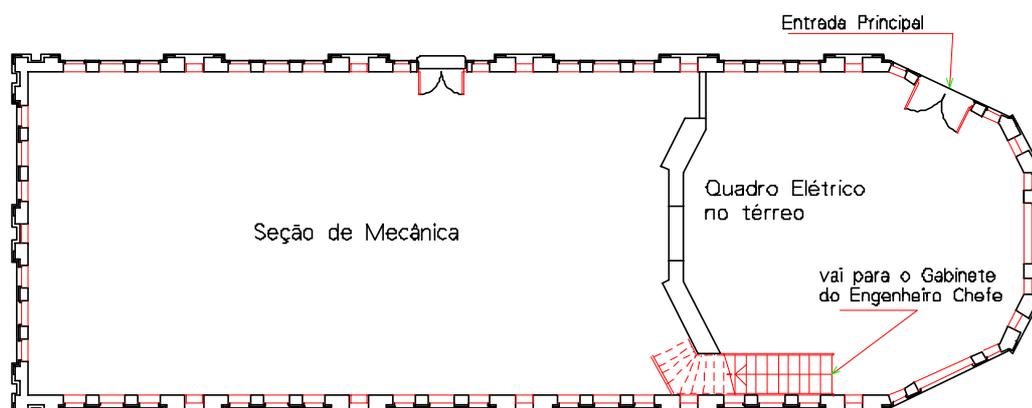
Planta Baixa do Castelinho, também com suas funções iniciais.
